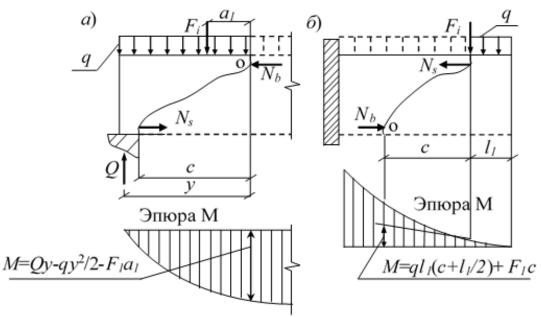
Определение расчетного значения момента при расчете наклонного сечения: a - ∂ ля свободно опертой балки; δ - ∂ ля консоли
